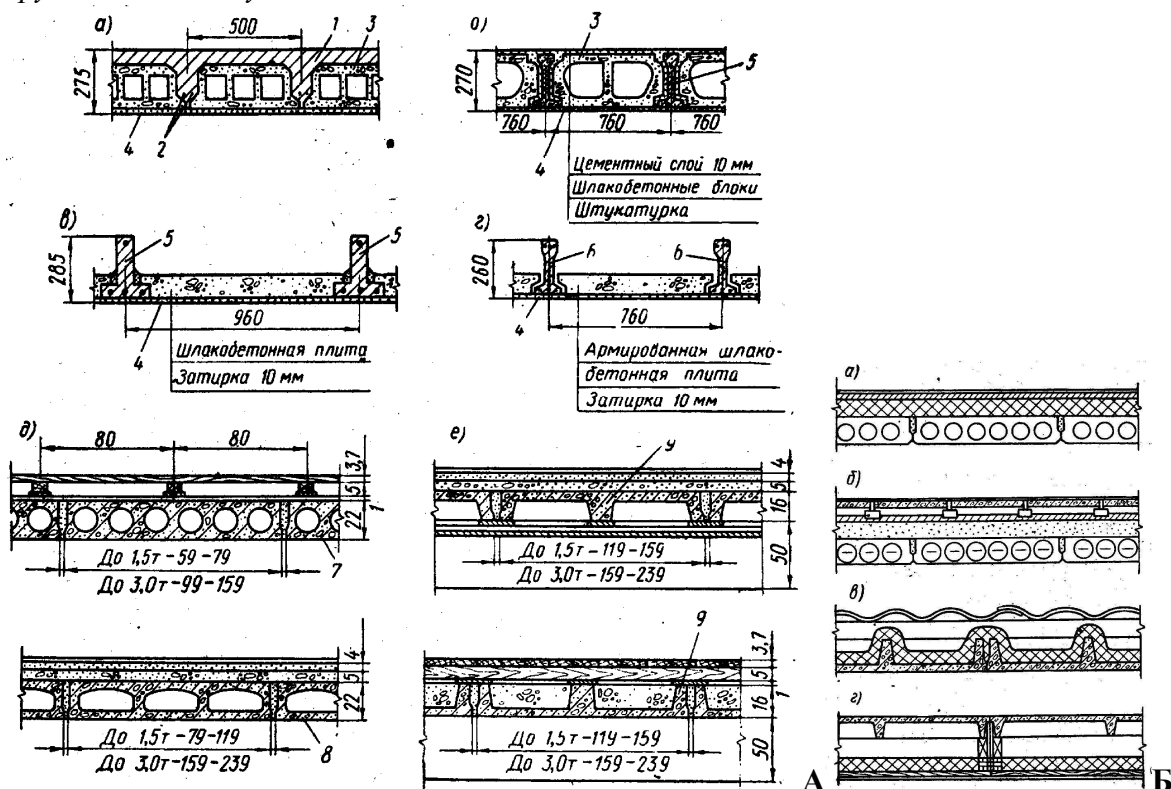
Приклади поверхового перекриття і покрівель. А – Типи міжповерхових перекриттів: а, б, в, г – перекриття з дрібних за розміром елементів; д, е – перекриття з панелей: 1 – бетонна підлога; 2 – арматура; 3 – шлакобетонні блоки; 4 – затірка; 5 – залізобетонні балки; 6 – залізобетонні таврові балки; 7 – панель з круглими пустотами; 8 – панель з овальними пустотами; 9 – ребристі панелі. Б – Типи суміщеного покриття: а – покриття з багато пустотними панелями з утепленням із комірчастого бетону; б - покриття з багато пустотними панелями з утепленням сипучим матеріалом; в - покриття з прокатними панелями (ребрами догори) з утепленням мінеральним волокном і дахом з хвилястих азбестоцементних листів; г - покриття з прокатними панелями (ребрами вниз) з підвісною утепленою стелею.
